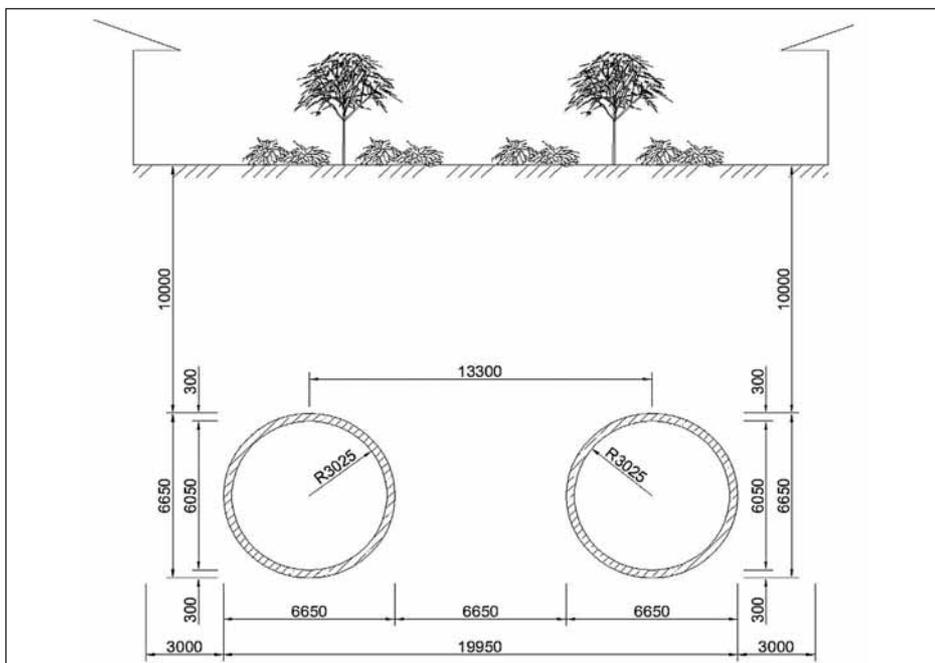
Схема поперечного сечения перегонных тоннелей метрополитена в Хошимине
